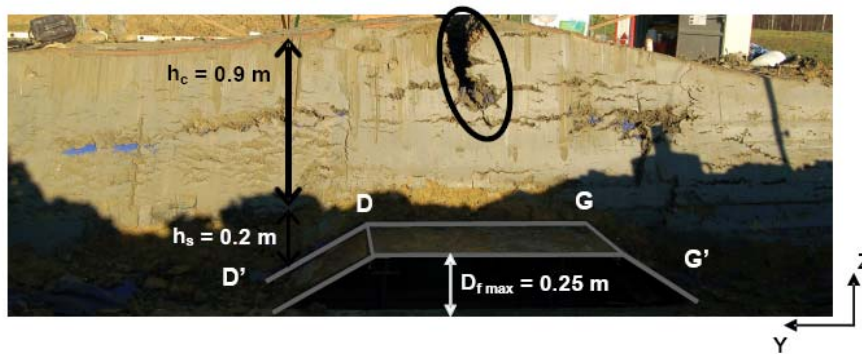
Coupe verticale de la planche T3 à la fin de l'essai
